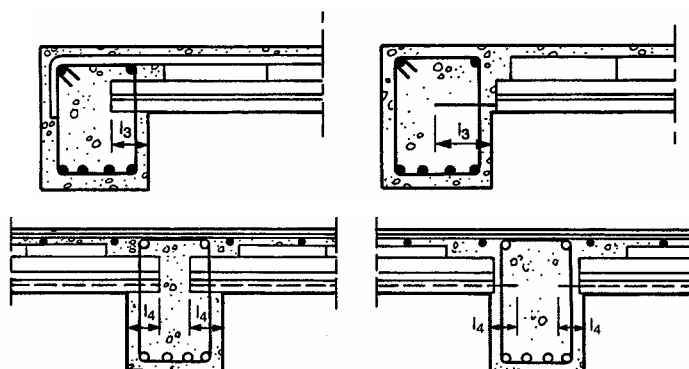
ligações nos apoios dos pisos de lajes com vigotas
